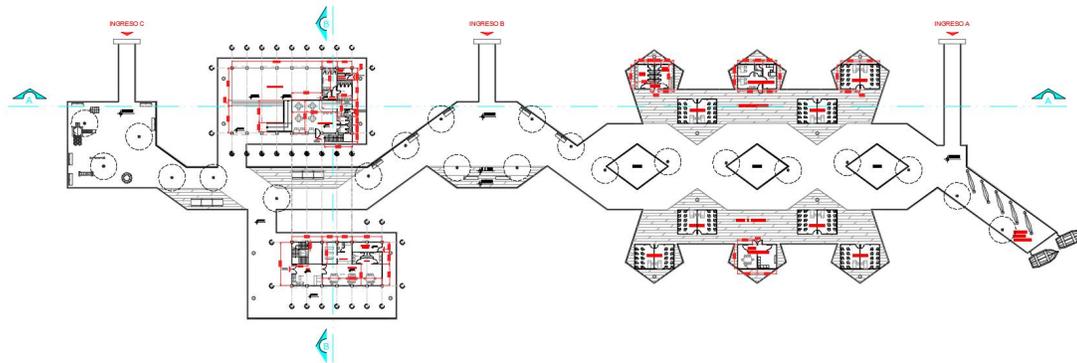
Plano Arquitectónico General Proyecto Titulación
